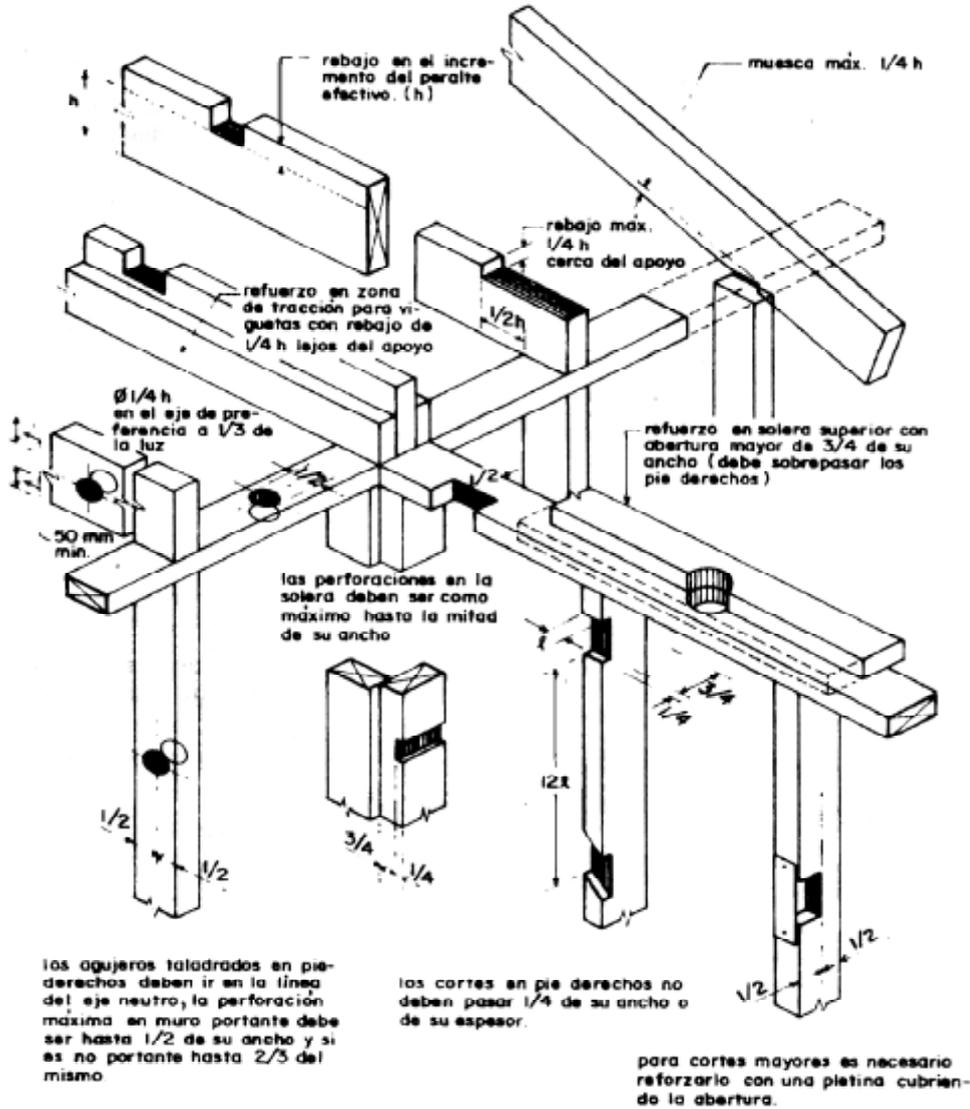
Perforaciones y rebajos en elementos de madera.
